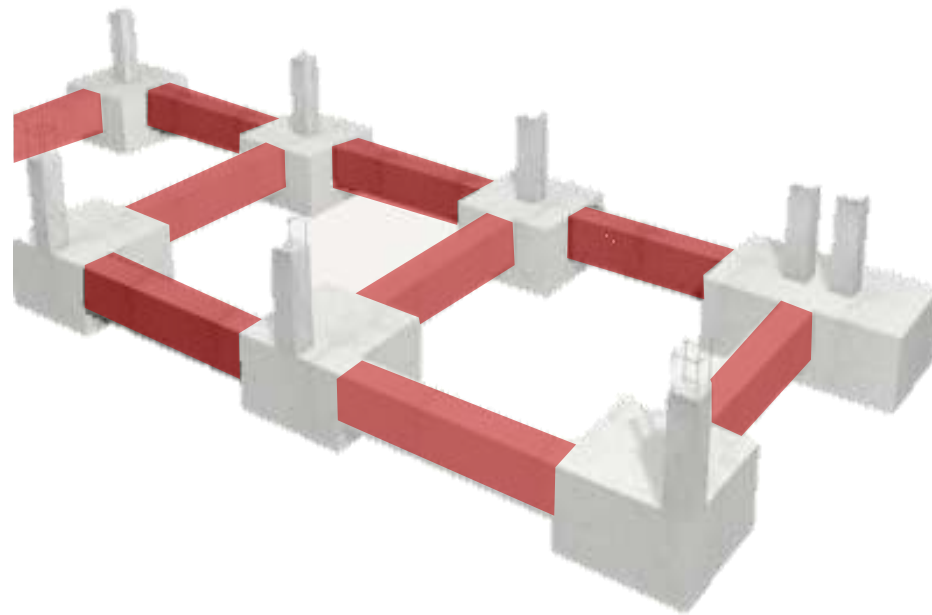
Propuesta de cimentación con Zapatas aisladas. Elaboración propia.
